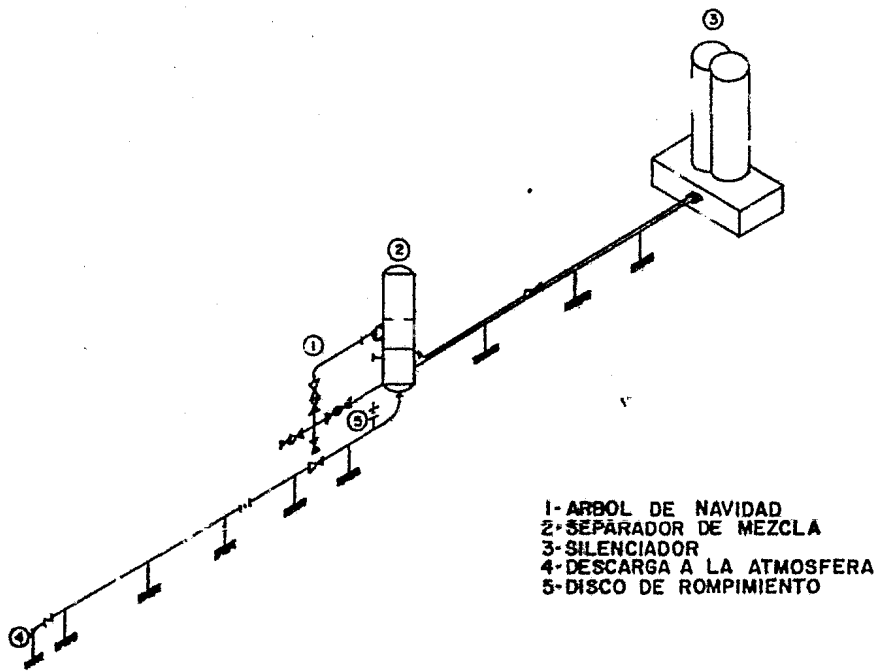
ARREGLO ESQUEMATICO Y VISTA EN PLANTA DEL POZO A-2
